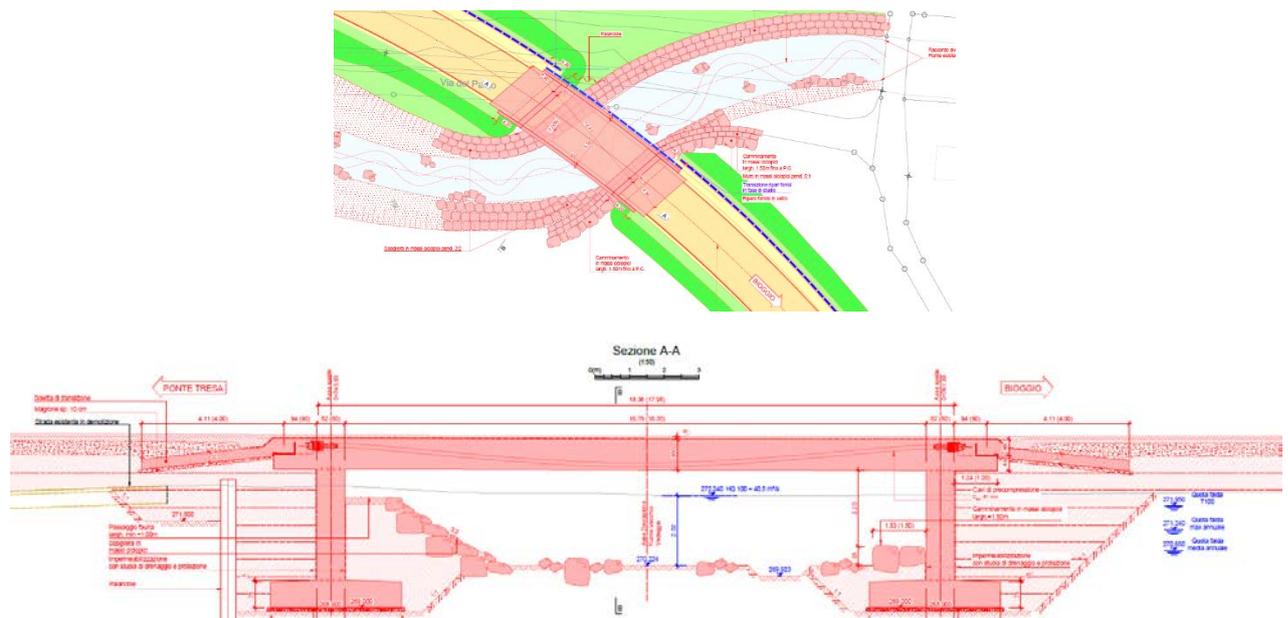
Planimetria e sezione longitudinale Ponte sul Vecchio Vedeggio
